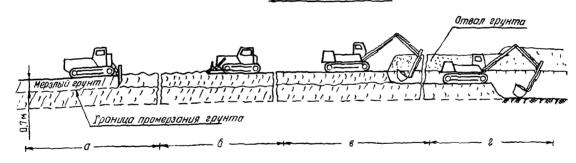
Разработка мерэлых грунтов с предварительным рыхлением их тракторными рыхлителями: а — рыхление грунта; б — производство планировочных работ; в — разработка разрыхленного мерэлого грунта; г — разработка траншем до проектной отметки
